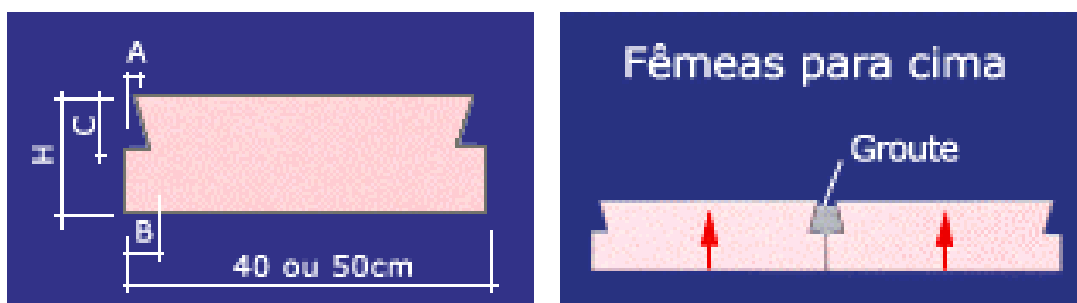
Seção de painel de CCA para Laje pré-moldada
